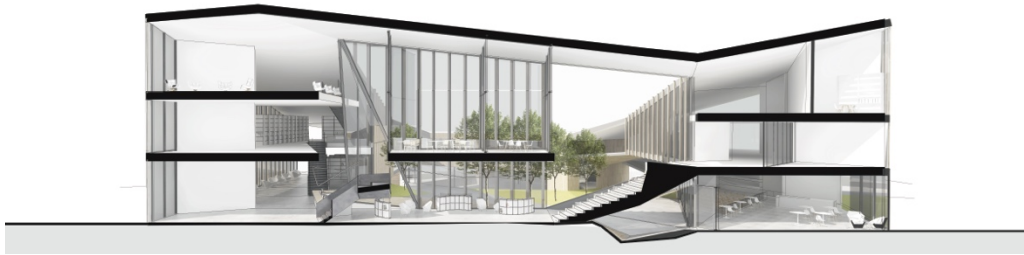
Coupe du bâtiment, illustration de l'auteur
